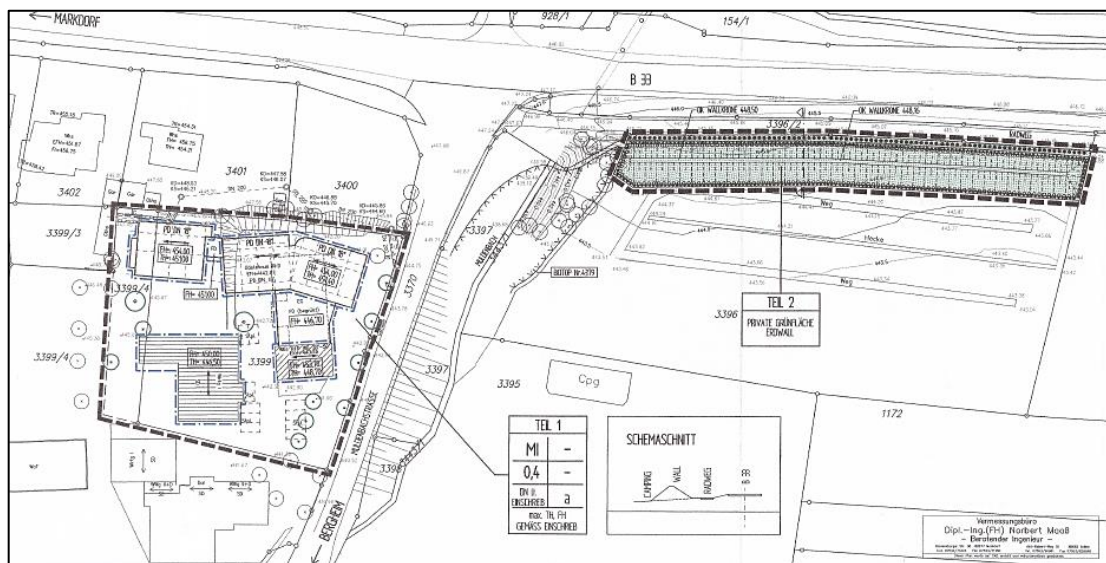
Auszug Bebauungsplan „Steibensteig (Campingplatz)“, o.M.
